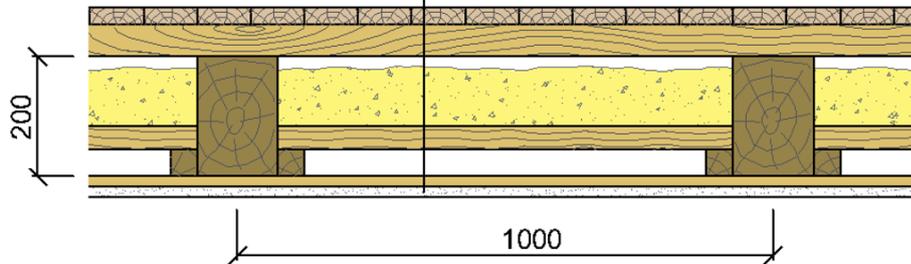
Конструкция перекрытия (сечение поперек пролета)
